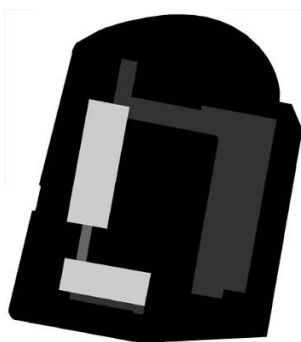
Esquema da planta de implantação da Escola Secundária de S. Lourenço, em Portalegre.
